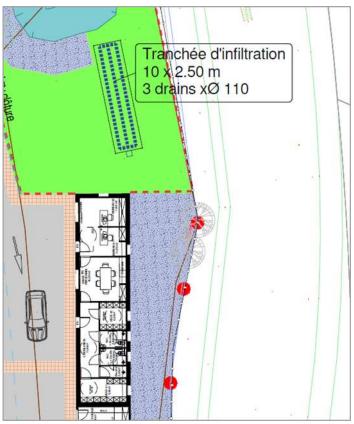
Tranchée d'infiltration des eaux pluviales de toiture
